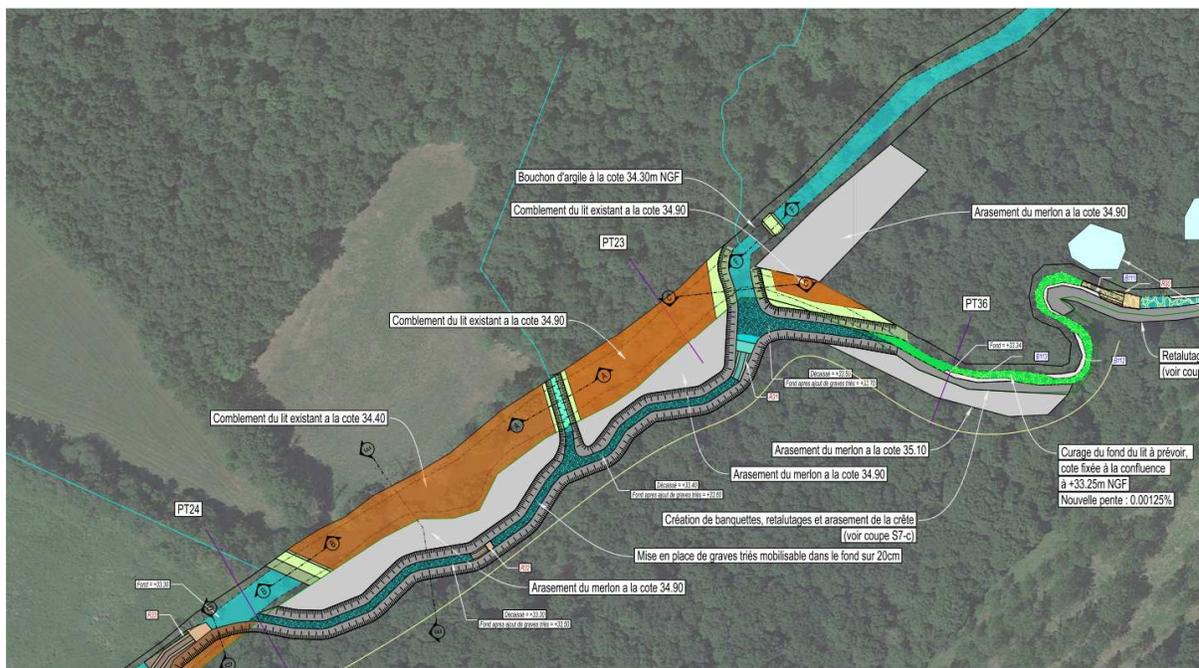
vue générale des travaux du Pont des Planches - secteur 7b.
